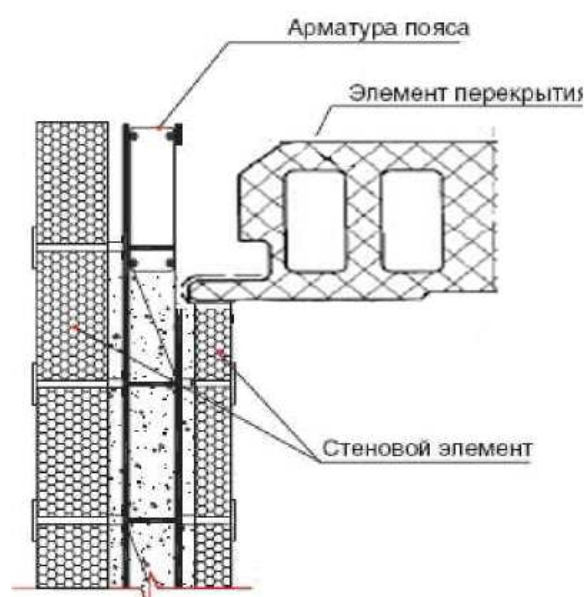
Выполнение опоры продольного края элементов опалубки перекрытия на внутренней ППС плите элементов стеновой опалубки системы PLASTBAU-3
